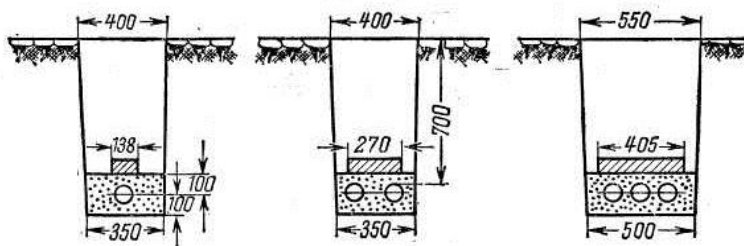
Прокладка кабелей в земляных траншеях
